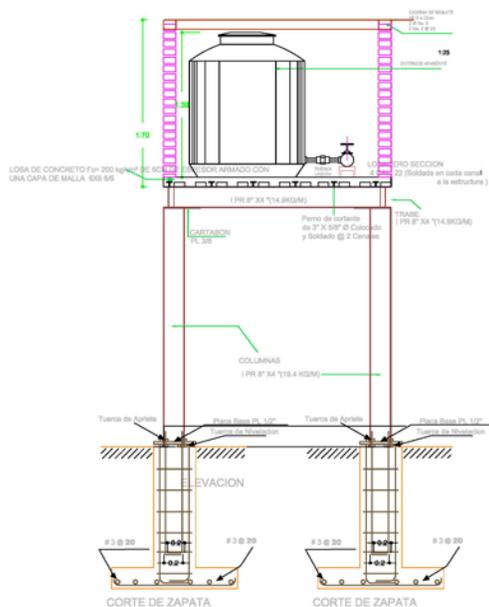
Alzado de cimentación, estructura y cubo de tinacos.
